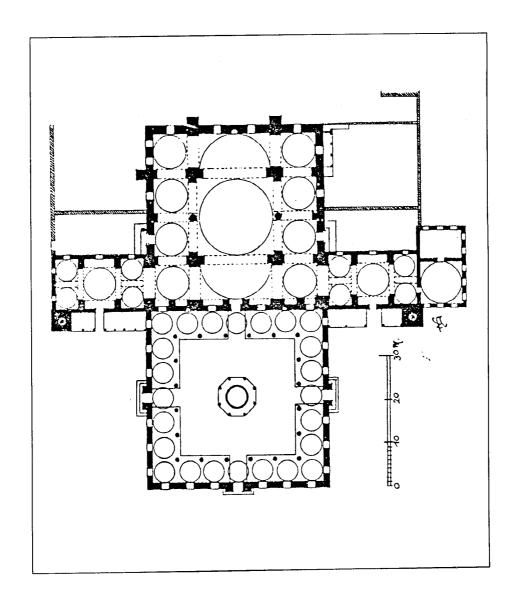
مسقط أفقي لمسجد ومدرسة سنان باشا في بشكطاش بإستانبول (عن : اصلان ابا) .
